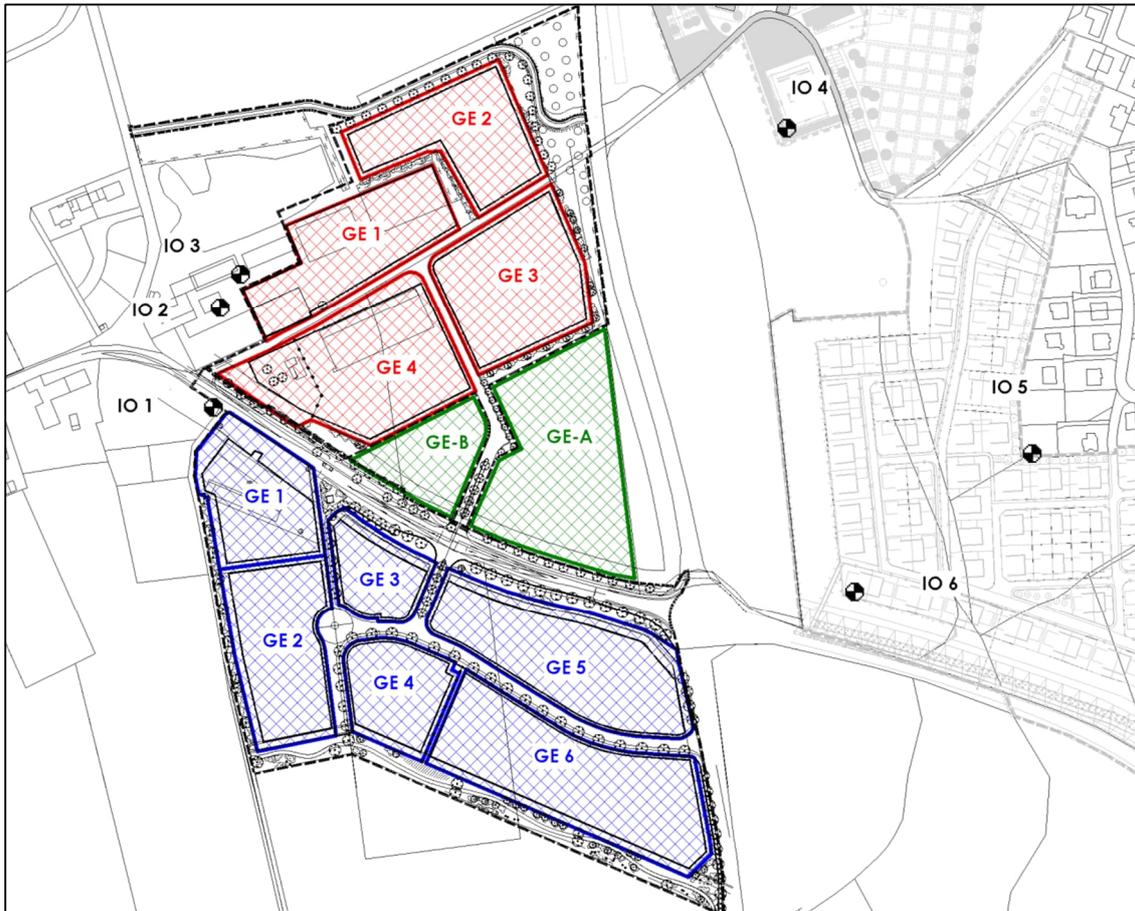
Lageplan mit Darstellung der Emissionsbezugsflächen einschließlich Vorhalteflächen
